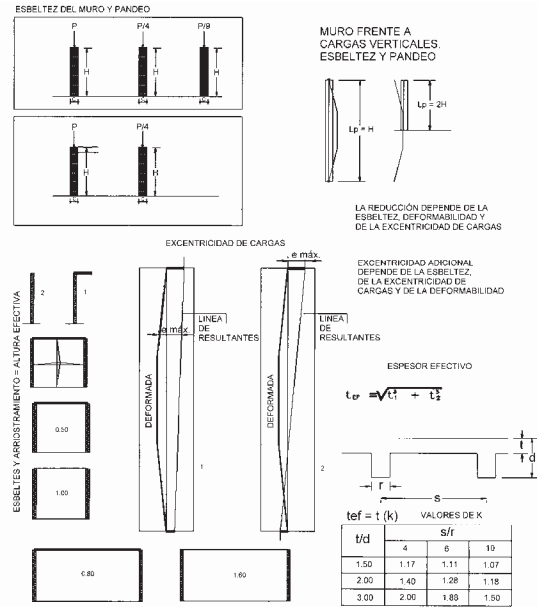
Muro bajo la acción de cargas verticales, esbeltez y pandeo.
